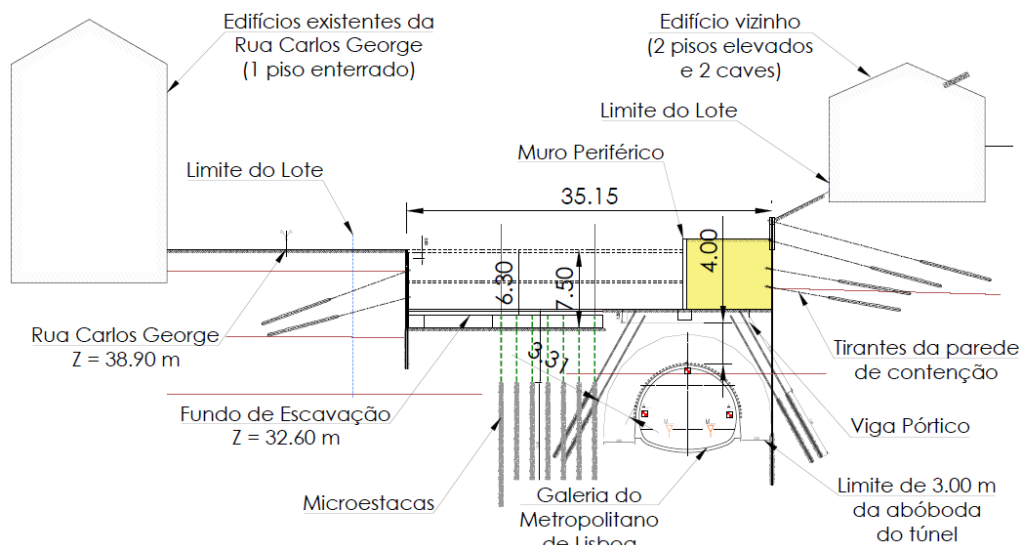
Secção do lote 1 (adaptado de JETSI, 2021).
